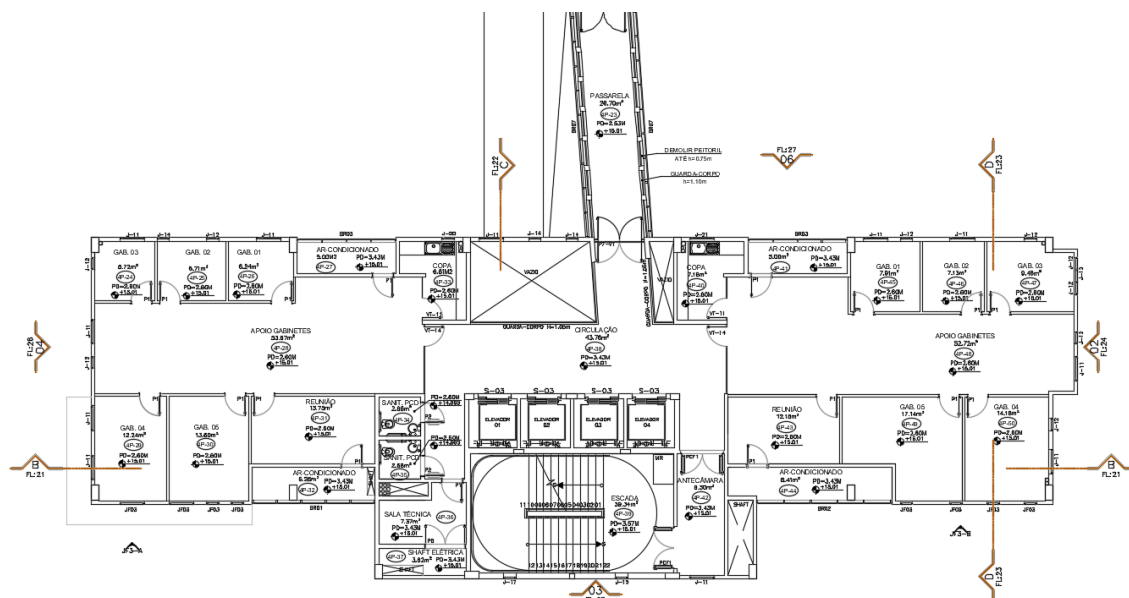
Planta baixa tipo do 4º a 8º pavimento da torre B.
